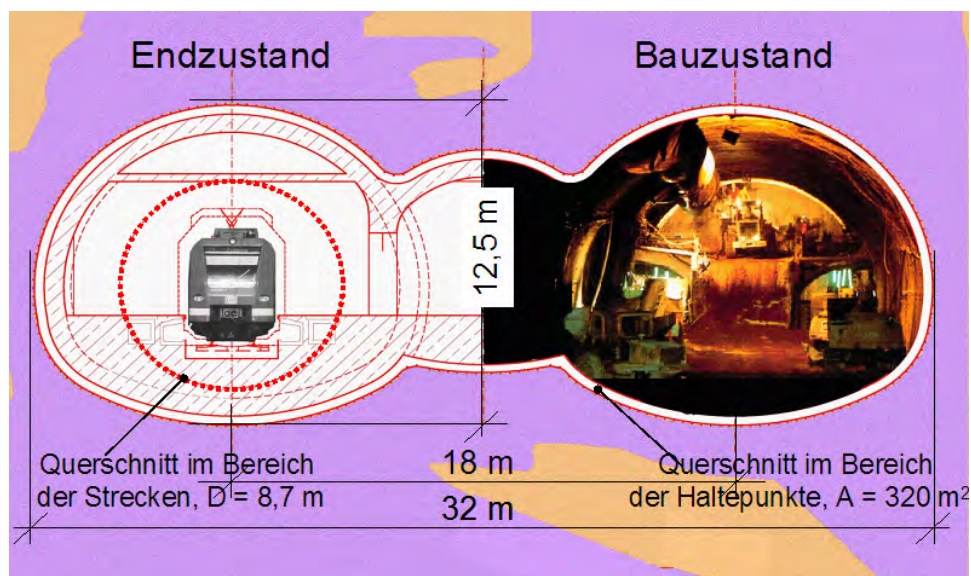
Tunnelquerschnitt in den Strecken und im Bereich der Haltepunkte
